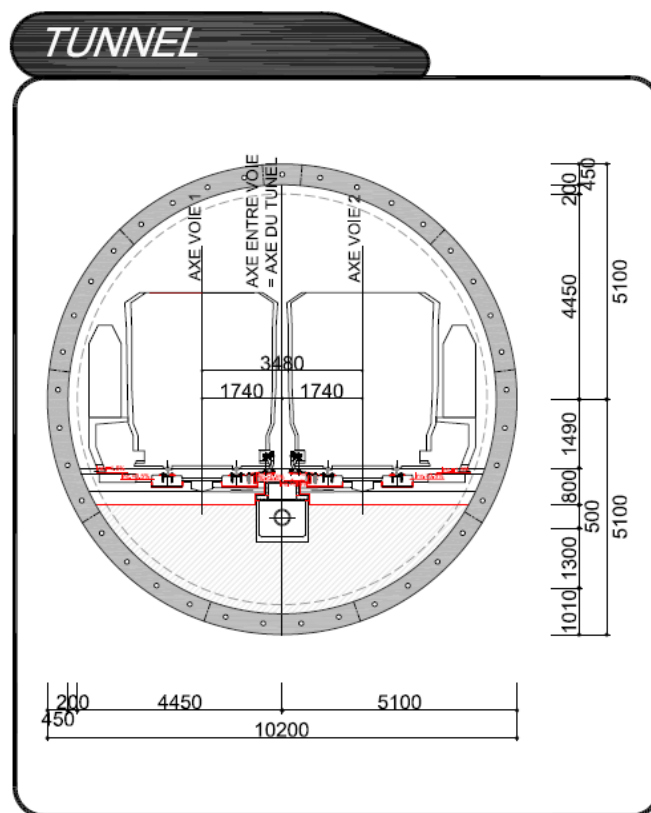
Section du tunnel de l'extension LOT1 du métro d'Alger [1].
